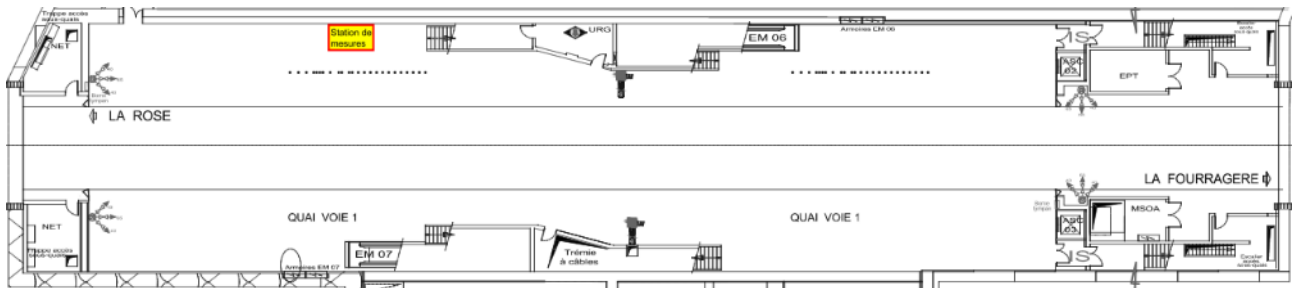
Positionnement de la station de mesure sur le plan du quai de la station La Blancarde (source RTM)
